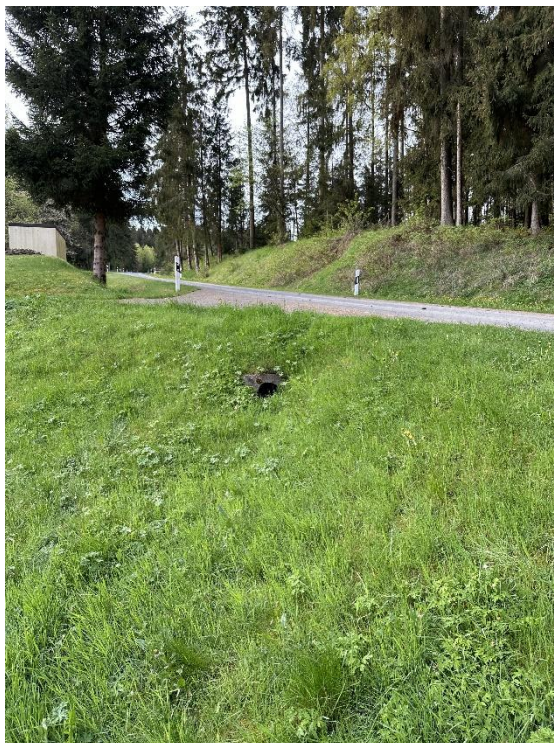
Einleitungsstelle 8 – Auslauf Straßengraben
